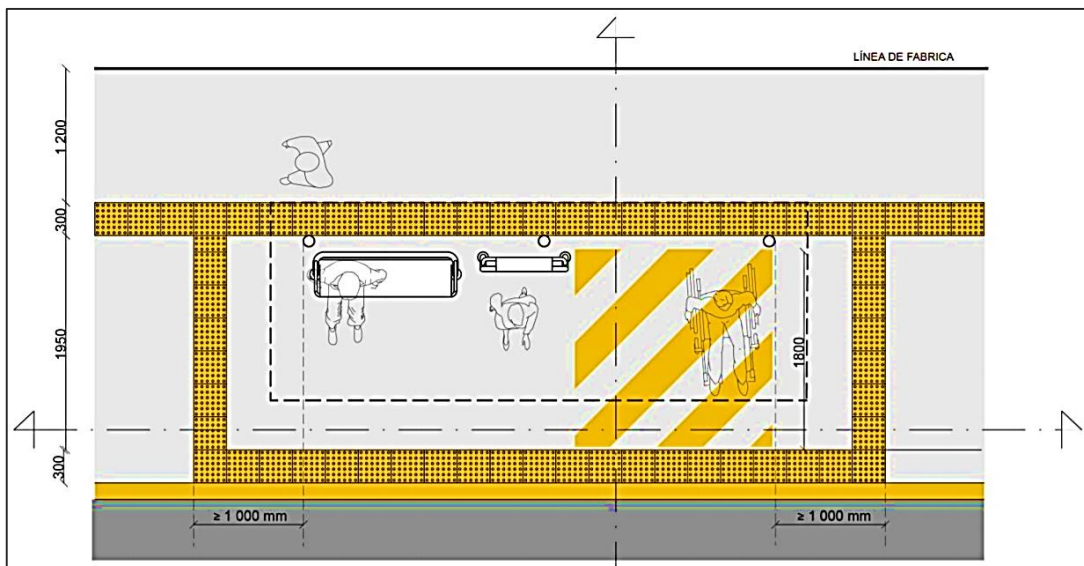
Medidas para la colocación de la marquesina – Vista de Planta
